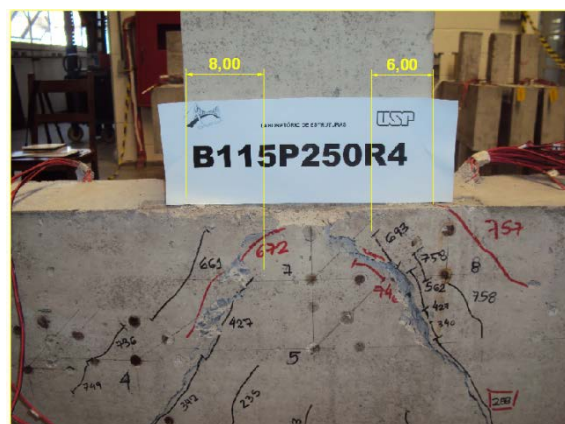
Distância da fissura principal a lateral do pilar do modelo B115P250R4
